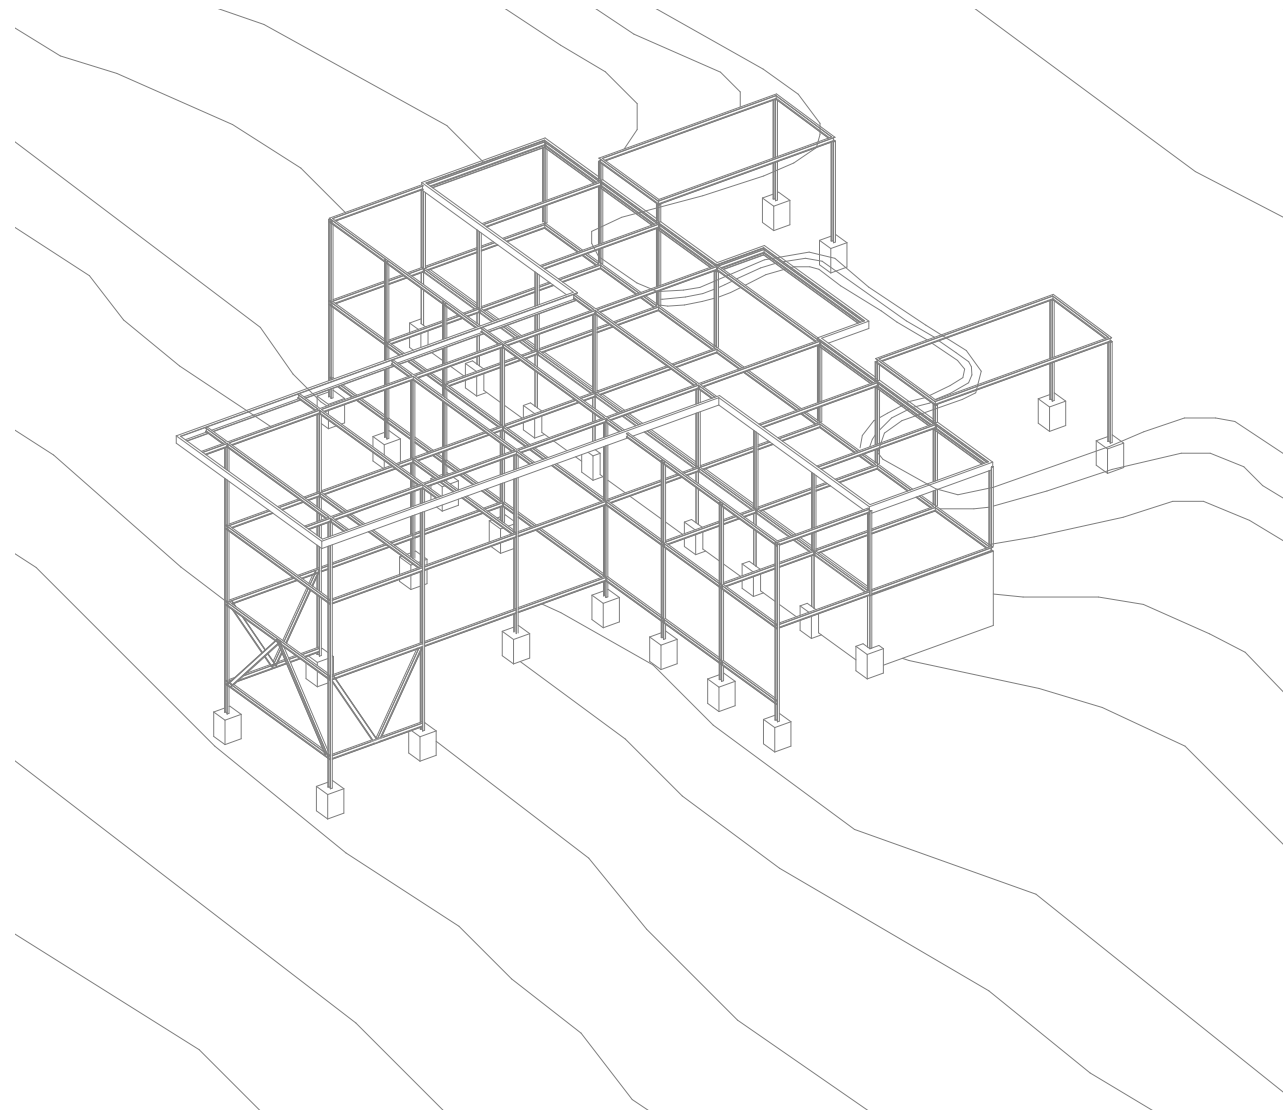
Craig Ellwood, Smith House (Glass House), LA, 1958, Axonometrie Tragwerk
